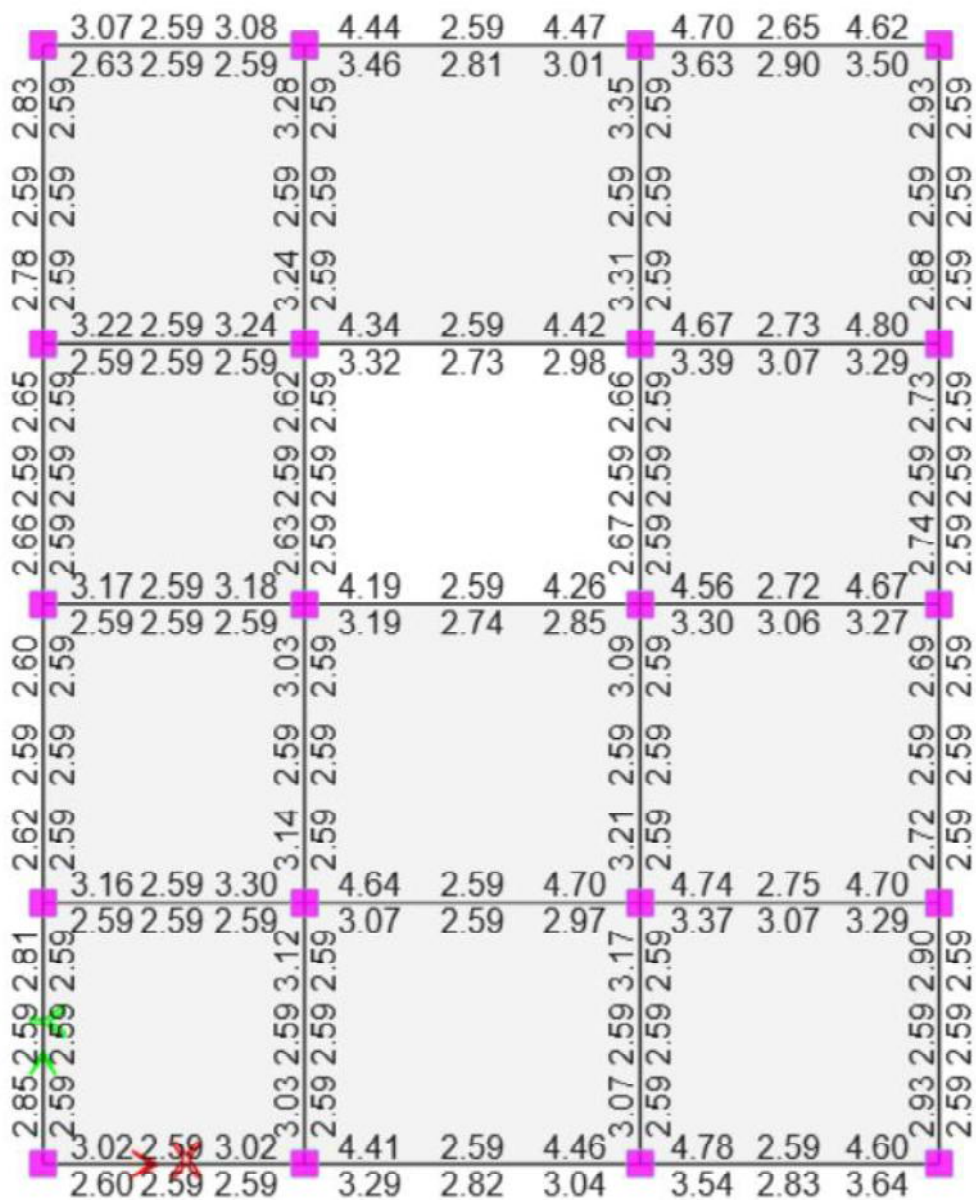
Refuerzo Longitudinal Vigas cm2 – Losa Nv+2.70 m
